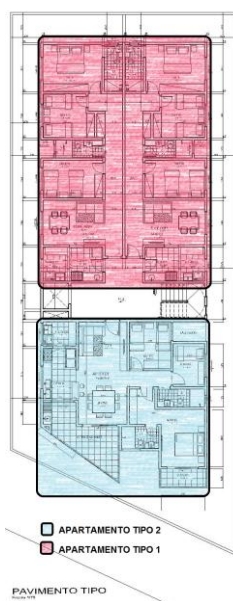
Pavimento Tipo - Projeto 1. Fonte: RDB Construtora com intervenções.
